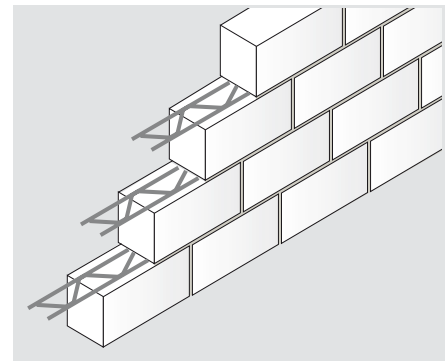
Lagerfugenbewehrung zur konstruktiven Rissesicherung in Normalmauermörtel
